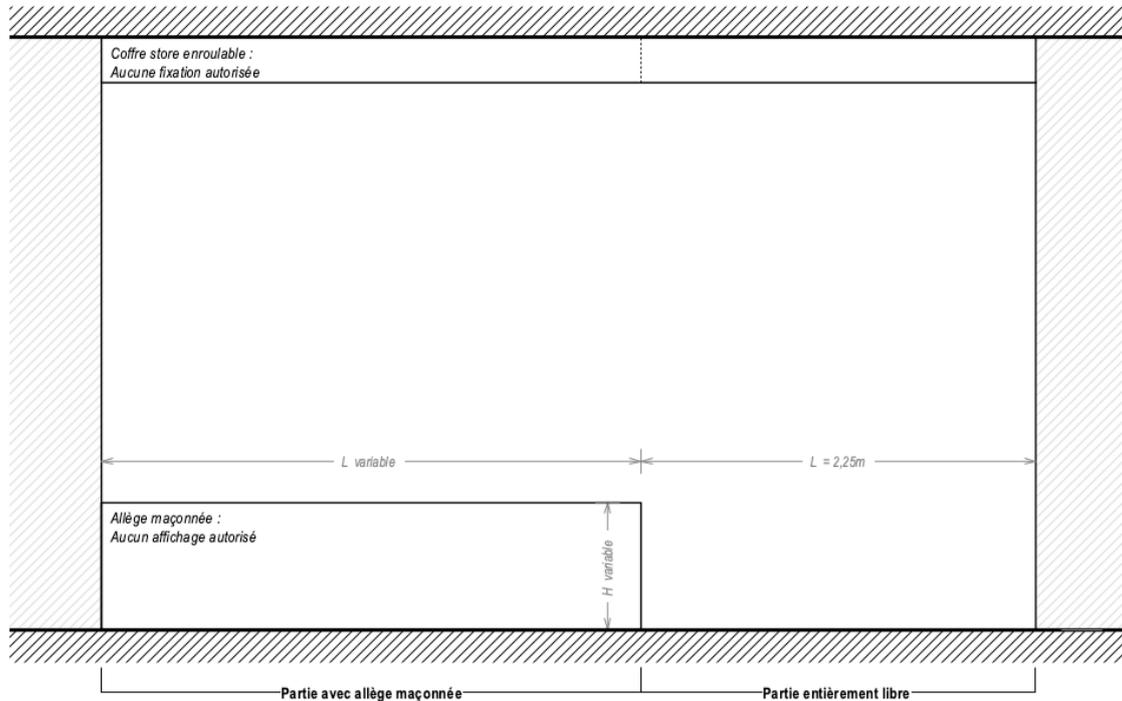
Croquis d'une façade type d'un étal traversant sur l'intérieur des Halles
